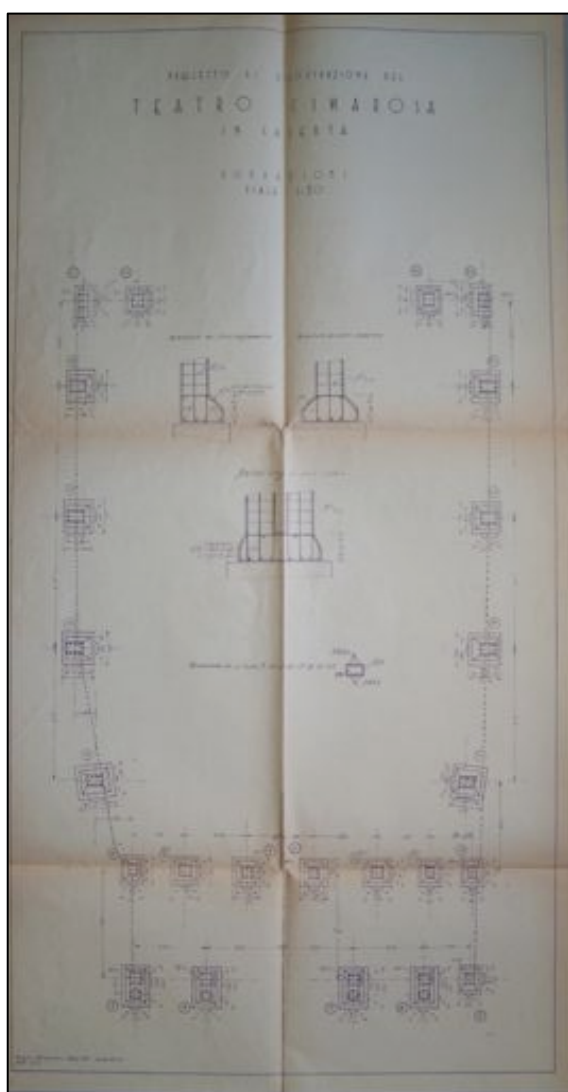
Progetto di ricostruzione del Teatro Cimarosa del 1934, schema delle fondazioni (ASCe, Fondo Genio Civile, cat.10, f. 1109)
